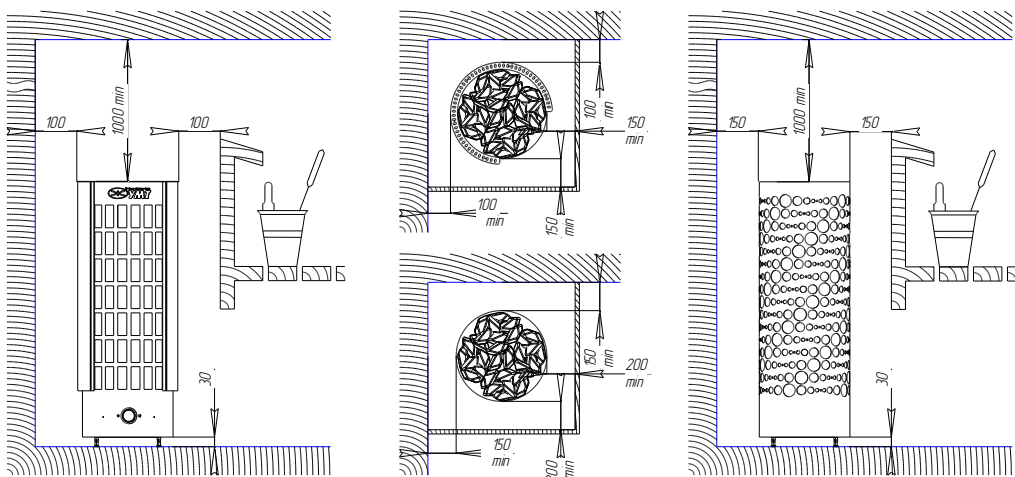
Схема установки (слева – с двойным кожухом, справа – с одинарным кожухом)
